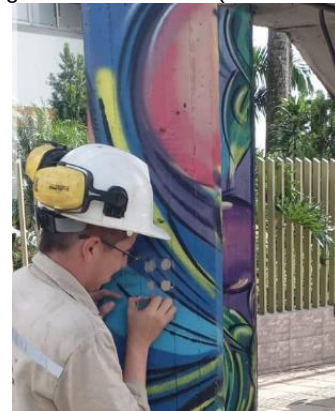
Columna con presencia de erosión en un vertice, columna 2
